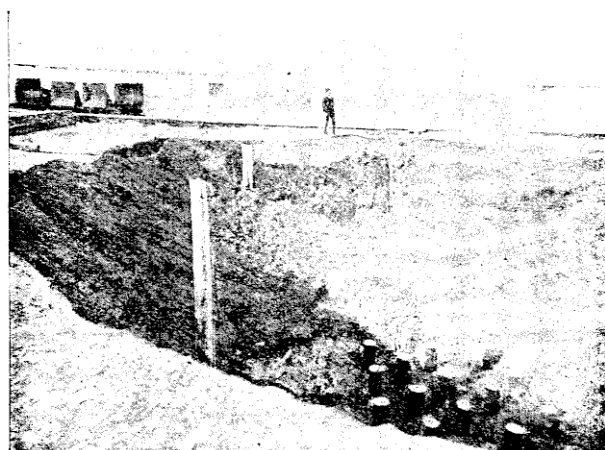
Fondations sur mauvais sol. — Pilotis.
